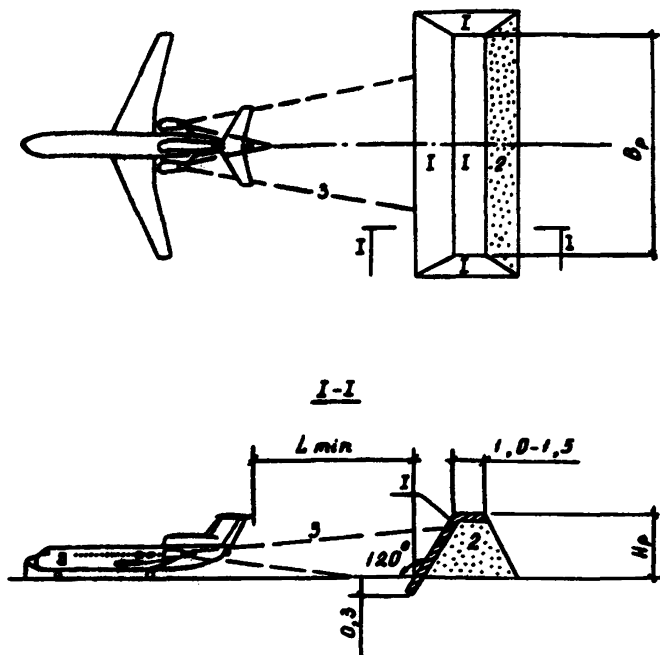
Струеотклоняющий щит в виде грунтового вала с бетонной облицовкой: 1 - монолитный или сборный бетон; 2 - насыпной грунт; 3 - газоздушная струя двигателя самолета; B_p , H_p - расчетная ширина и высота щита; L_{min} - минимальное удаление от крайней точки хвостового оперения самолета.
